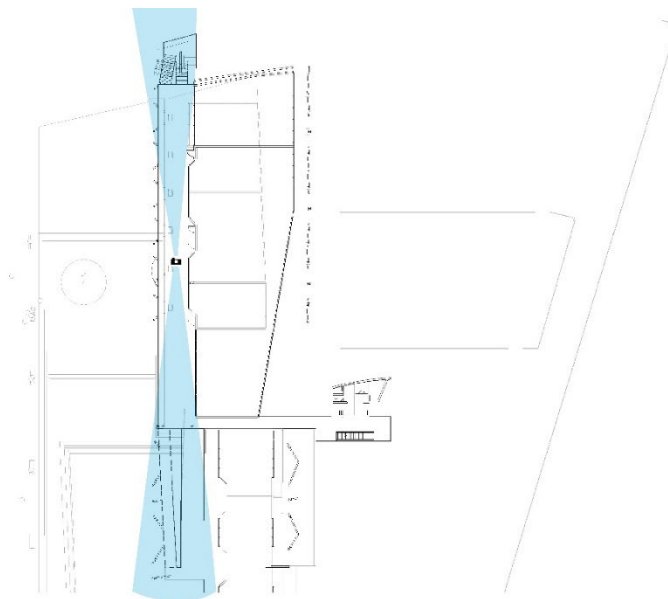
Elaboración propia. Plano de segunda planta del edificio con posición de cámara de mano.
